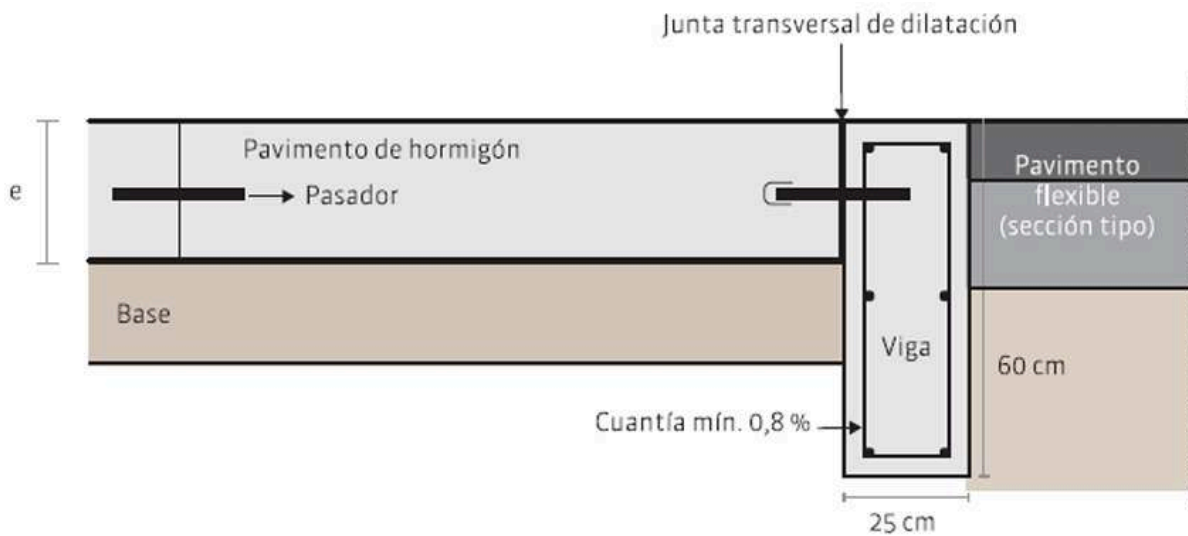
Características de los pasadores. Fuente: Manual de Diseño y Construcción de Pavimentos de Hormigón, del ICPA (Instituto del Cemento Portland Argentino) Capítulo 3.
